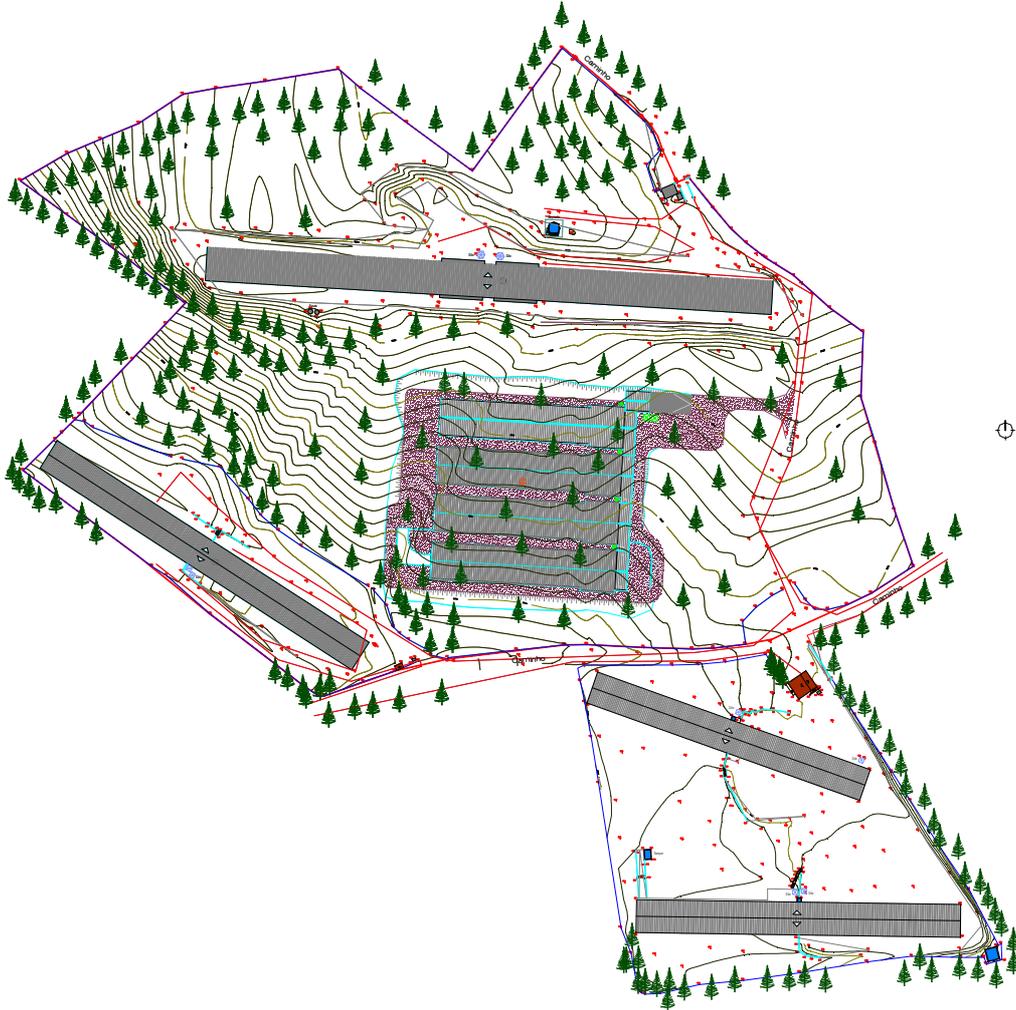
Planta geral da propriedade visada. Área a edificar assinalada a lilás.
